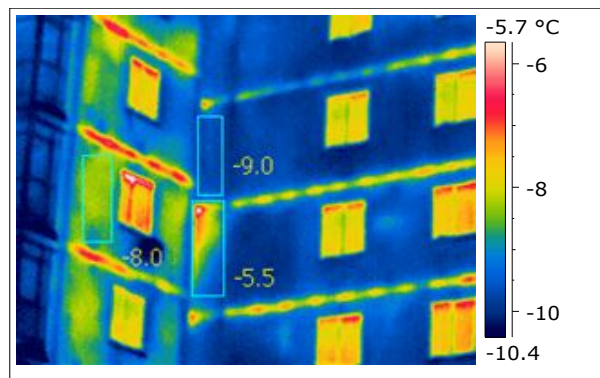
Локальное нарушение технологии монтажа и конструкций и укладки утеплителя стен
